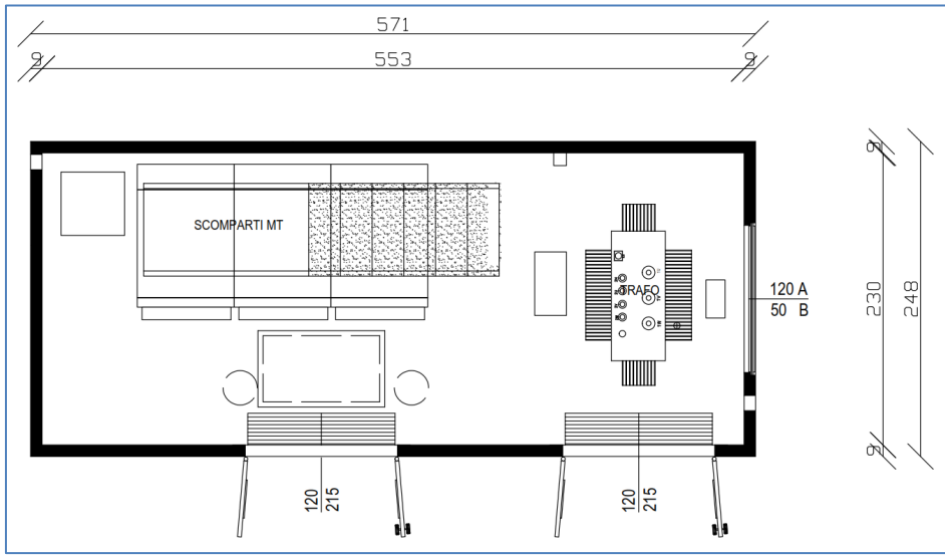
Vista in pianta della cabina di sezionamento del Gestore di Rete
